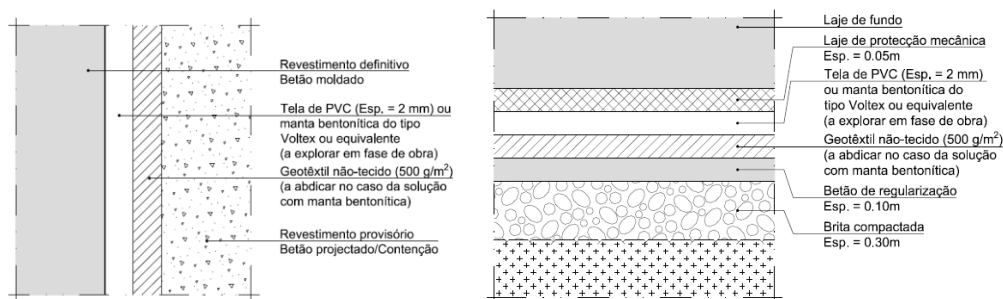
Sistema de impermeabilização do revestimento definitivo das estruturas executadas a céu aberto
